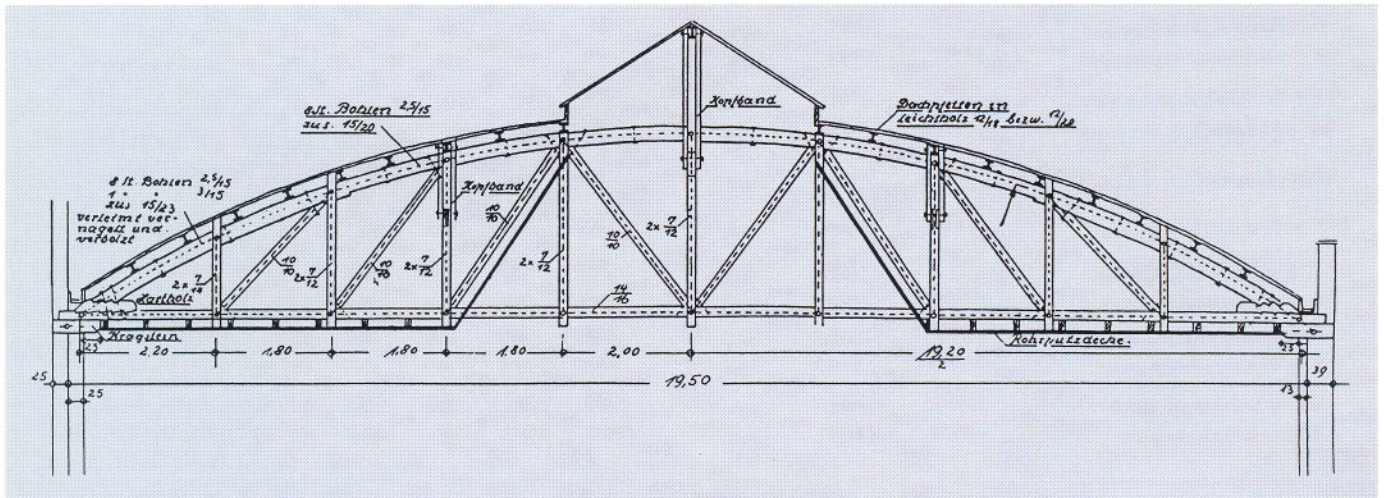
Autowaschhalle in Kassel, Fachwerk-Brettschichtkonstruktion, Spannweite 19,50 m
